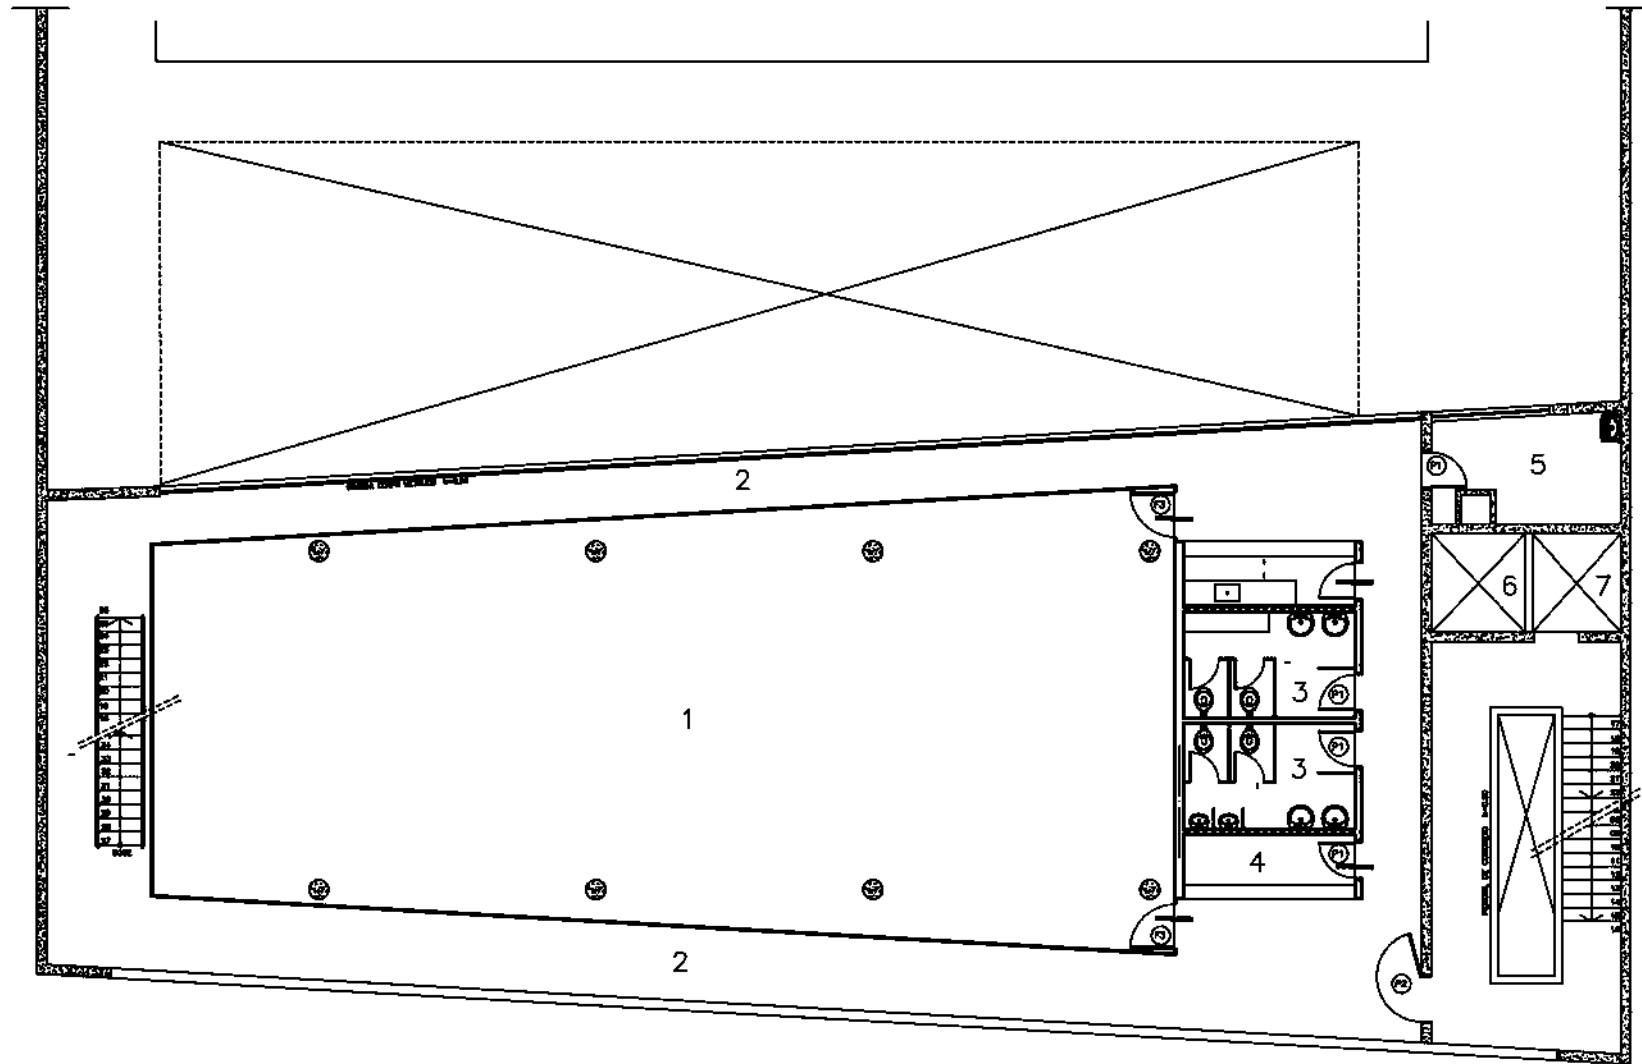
Planta do 1º pavimento do prédio novo (1. cursos; 2. circulação; 3. sanitários; 4. informações; 5. depósito; 6. monta-carga; 7. poço do elevador). Fonte: Acervo Brasil Arquitetura.
